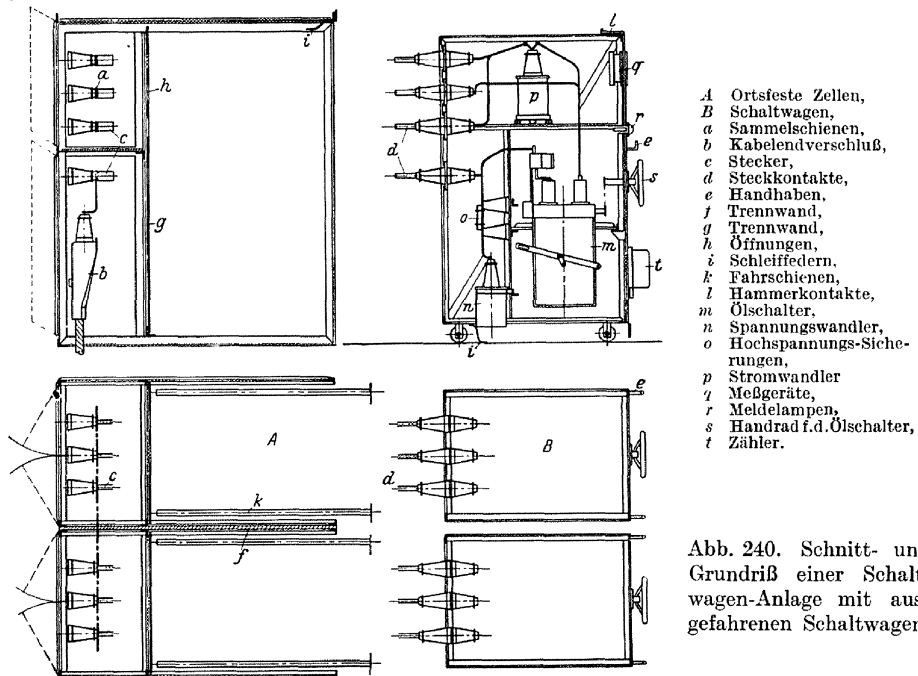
Schnitt- und Grundriß einer Schaltwagen-Anlage mit ausgefahrenen Schaltwagen
